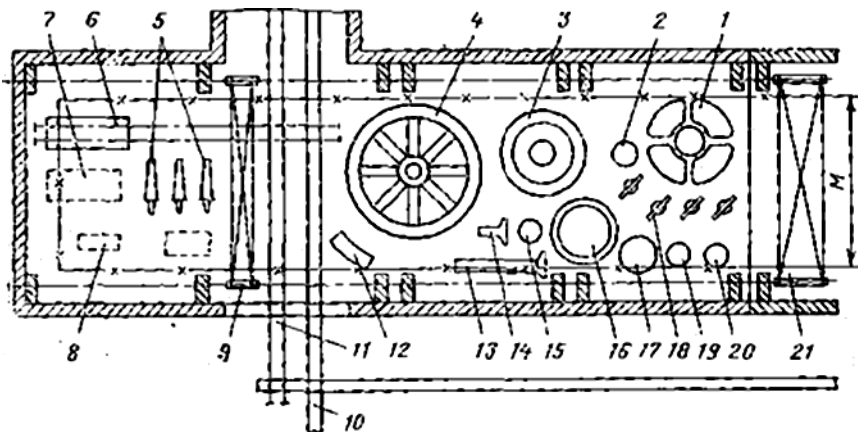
Раскладка оборудования на монтажной площадке:
